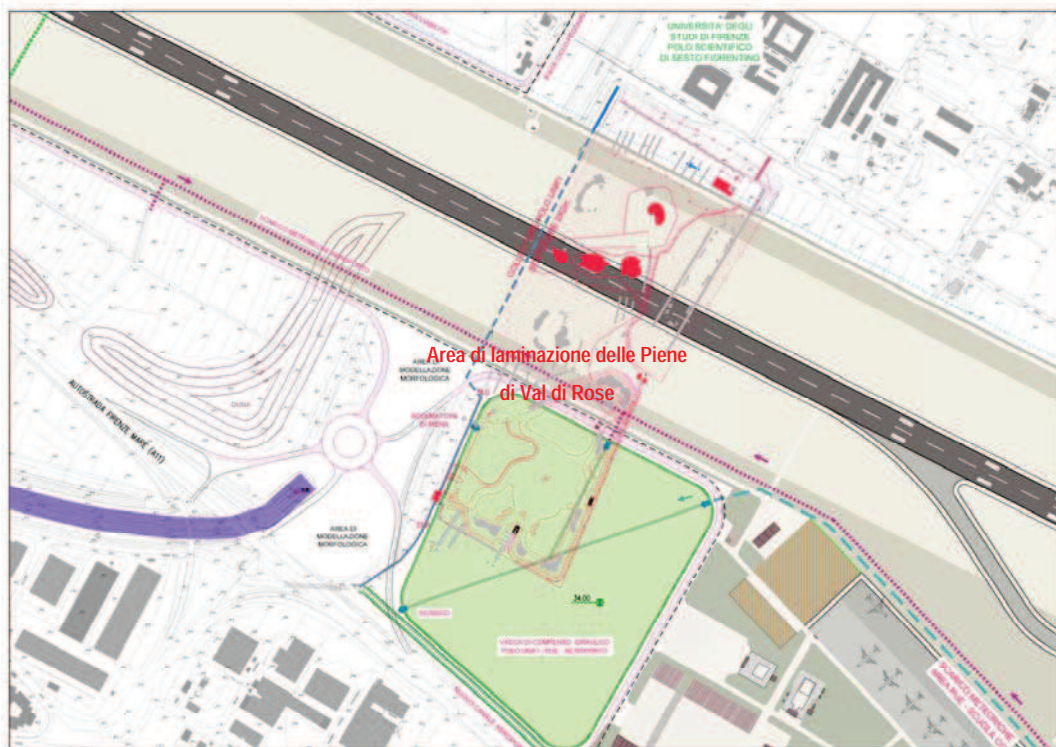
Stralcio Planimetrico dell'area di laminazione delle piene di Val Di Rose
